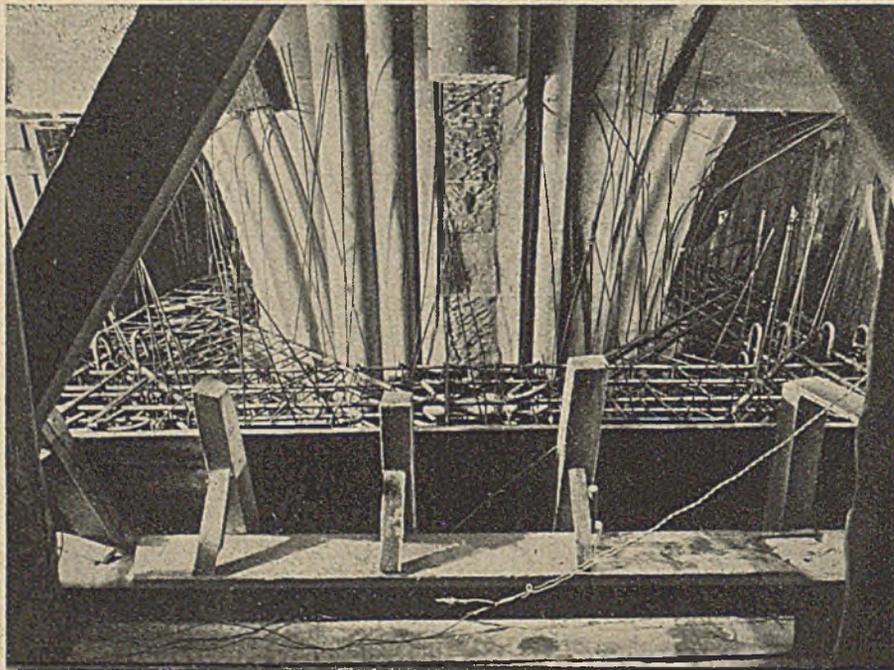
Abfangung des Schiffspfeilers B durch Eisenbetonkragen auf Holzrüstung.
